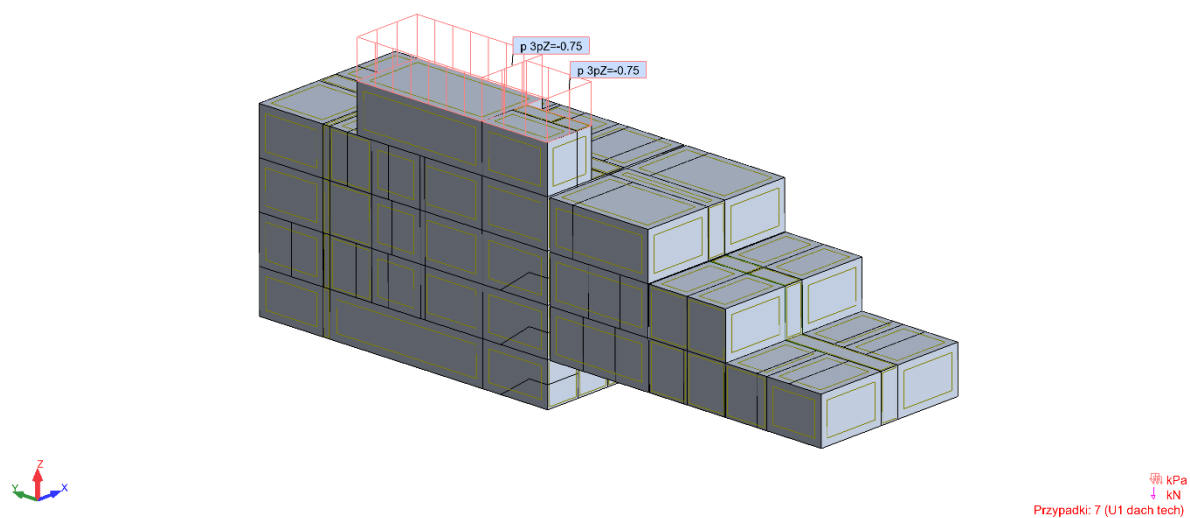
Przypadek obciążenia użytkowego od dachu ekstensywnego
